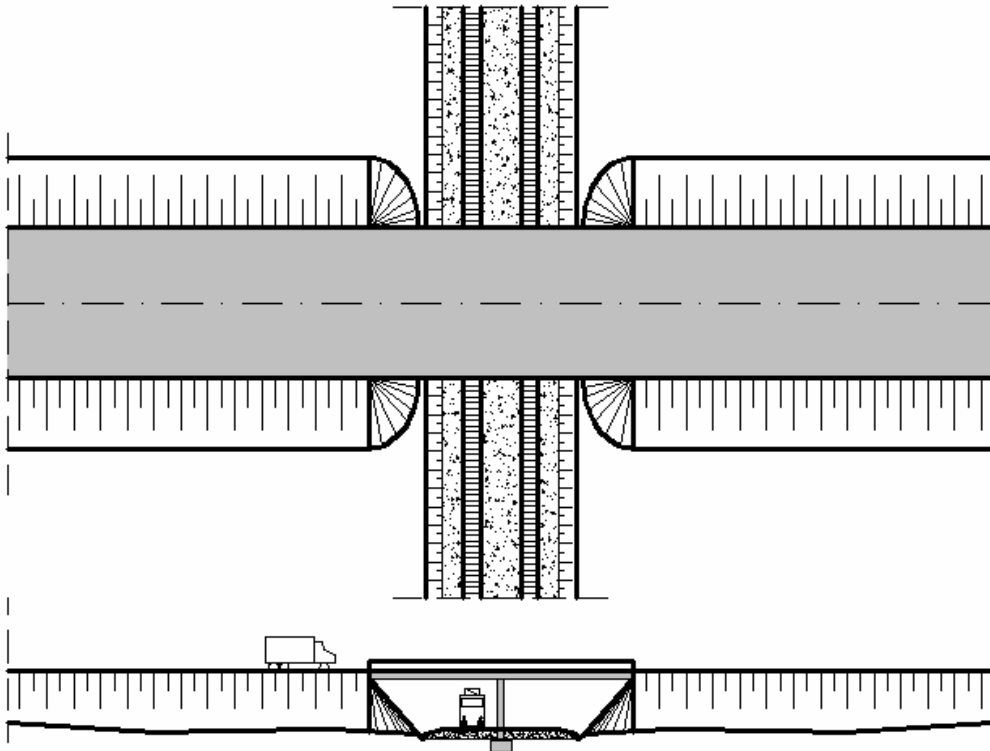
Vedere în plan și în elevație a unui pasaj superior
